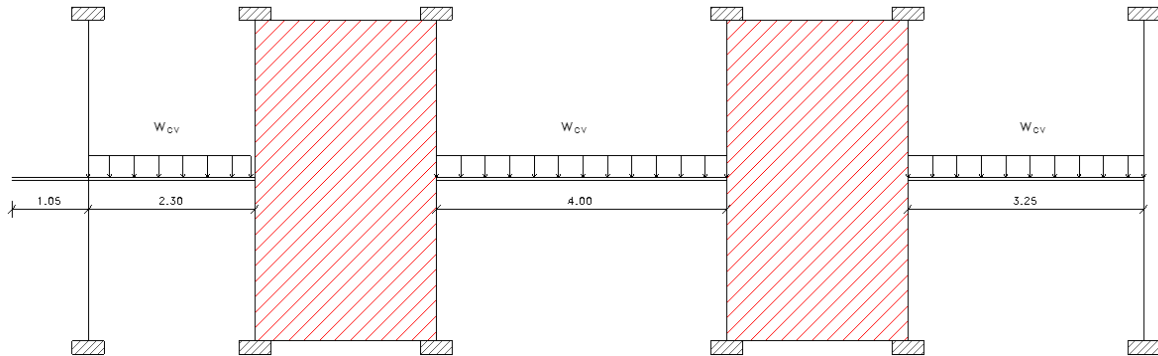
Modelo Matemático con carga viva de la viga N°8
